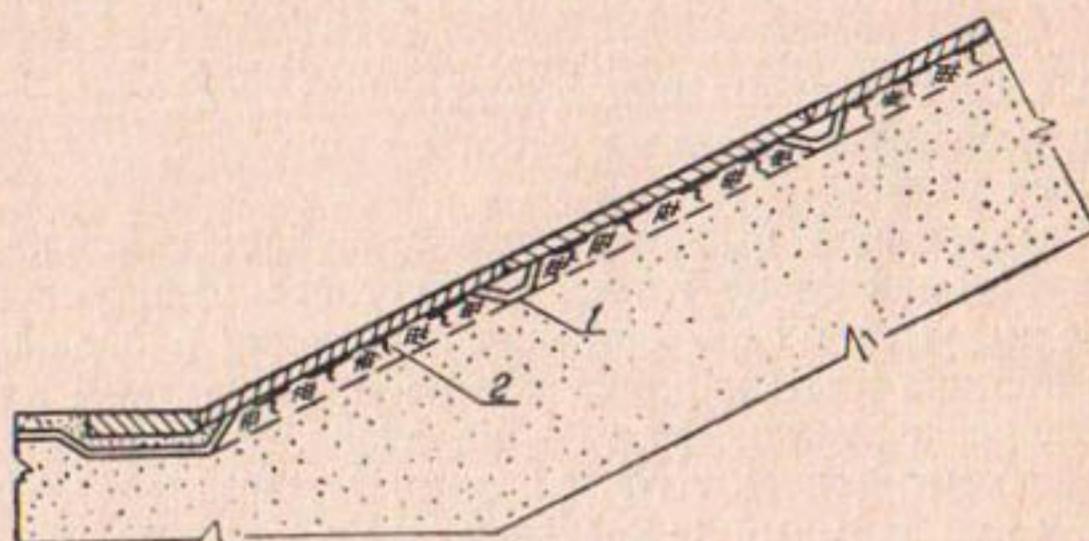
Конструкция крепления из монолитных армобетонных плит:
